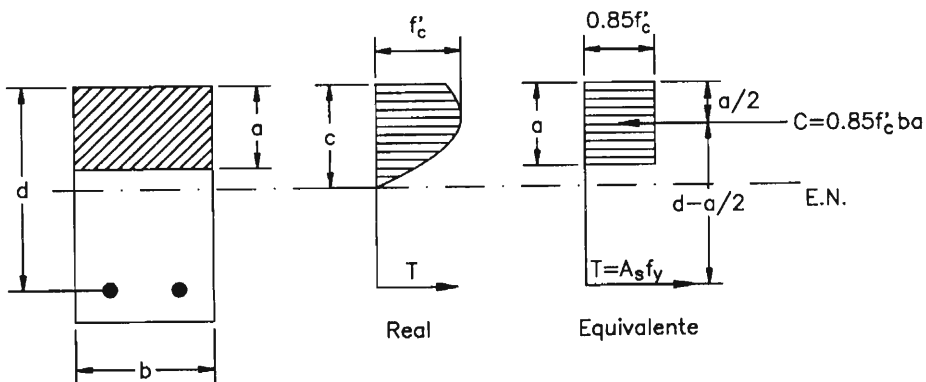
Esfuerzos en una sección rectangular con refuerzo en tensión sometida a flexión
